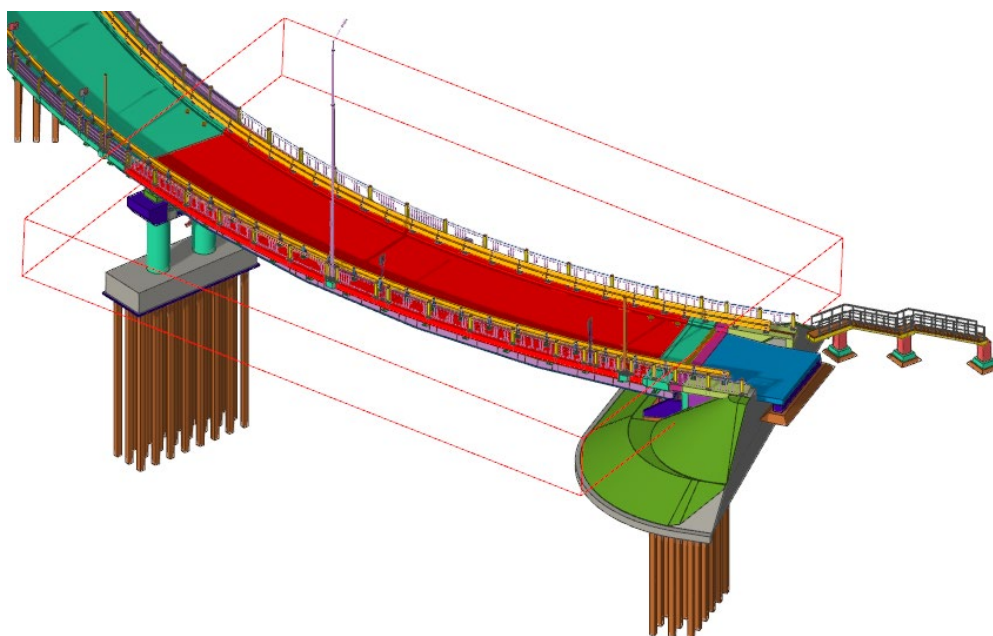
Элемент ЦИМ «железобетонная плита пролетного строения»
